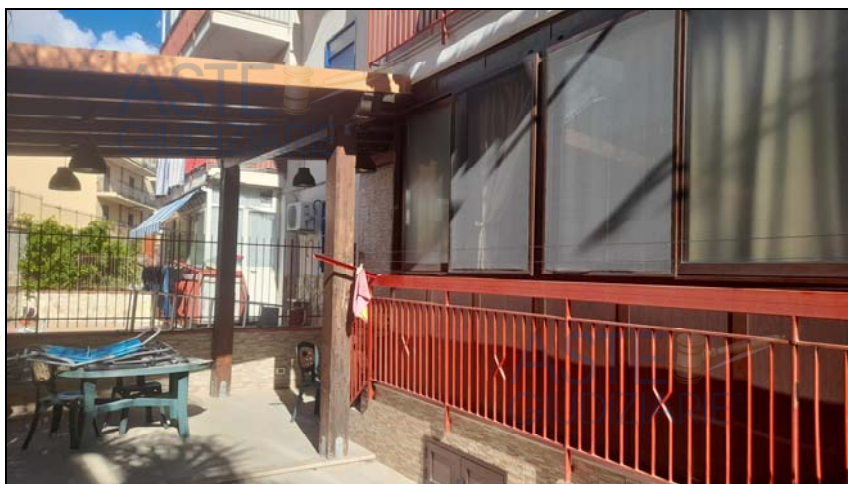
Tettoia e veranda su villetta 1 (prospetto posteriore)
